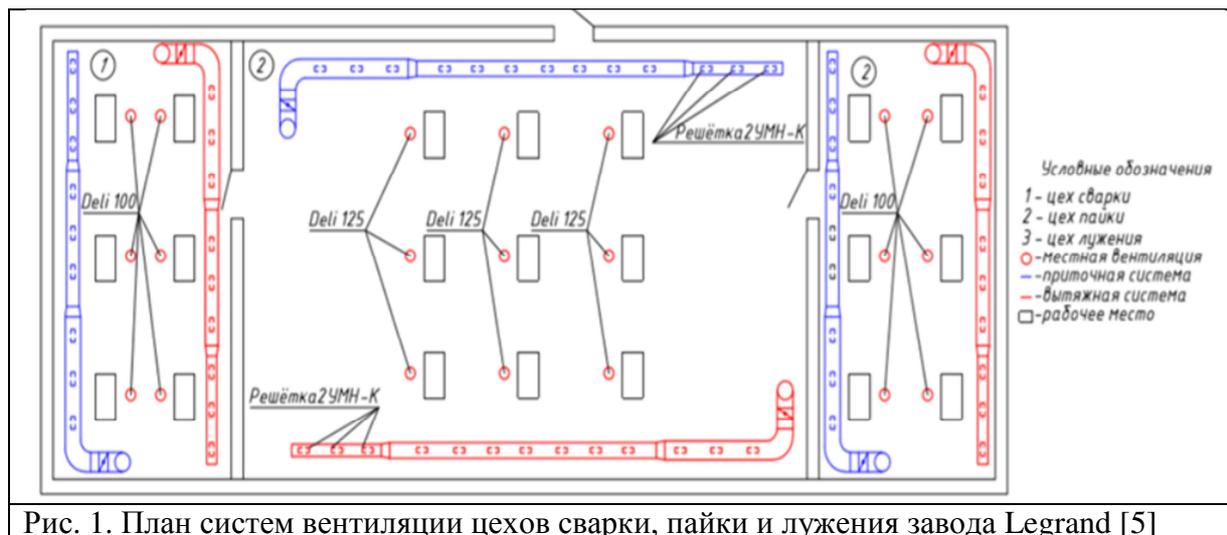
План систем вентиляции цехов сварки, пайки и лужения завода Legrand [5]
